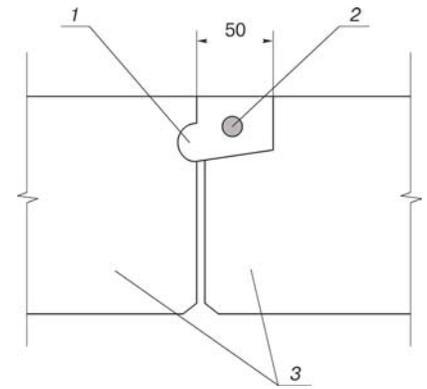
Пример узла сопряжения плит перекрытия и перекрытия между собой: 1 – замоналиченный шов; 2 – арматурный стержень; 3 – ячеисто-бетонные плиты
